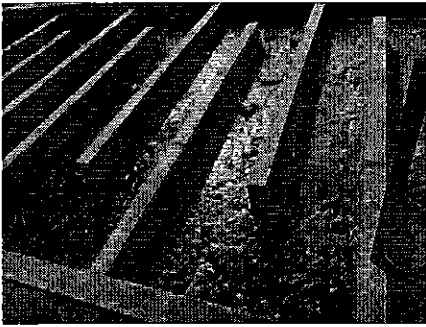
Floculadores Planta de Tratamiento de la EPMAPAL - Latacunga
